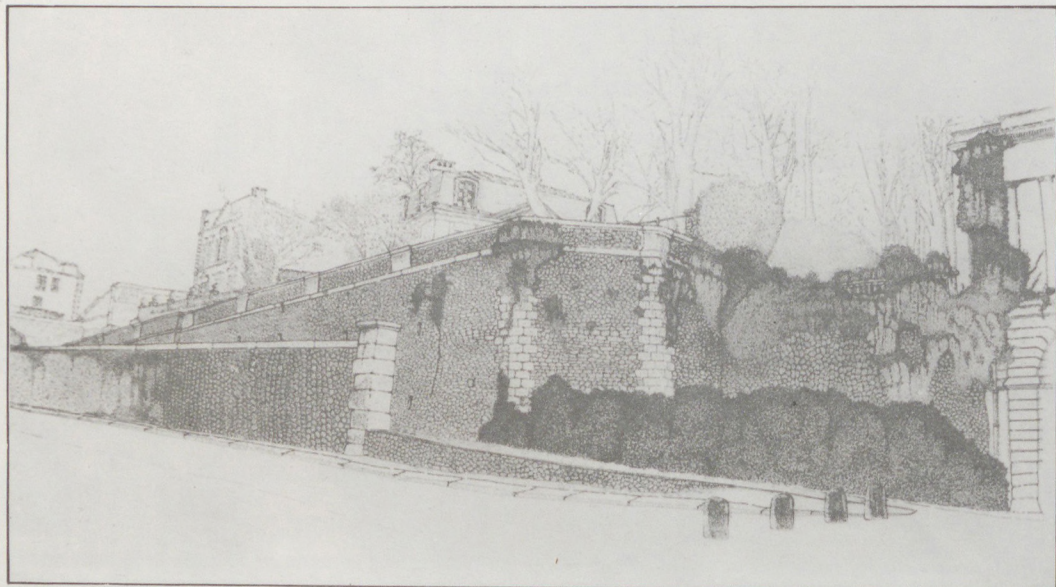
et 13 : murs de soutènement, avenue de St-Cloud, au pied de la colline de Montbauron.
